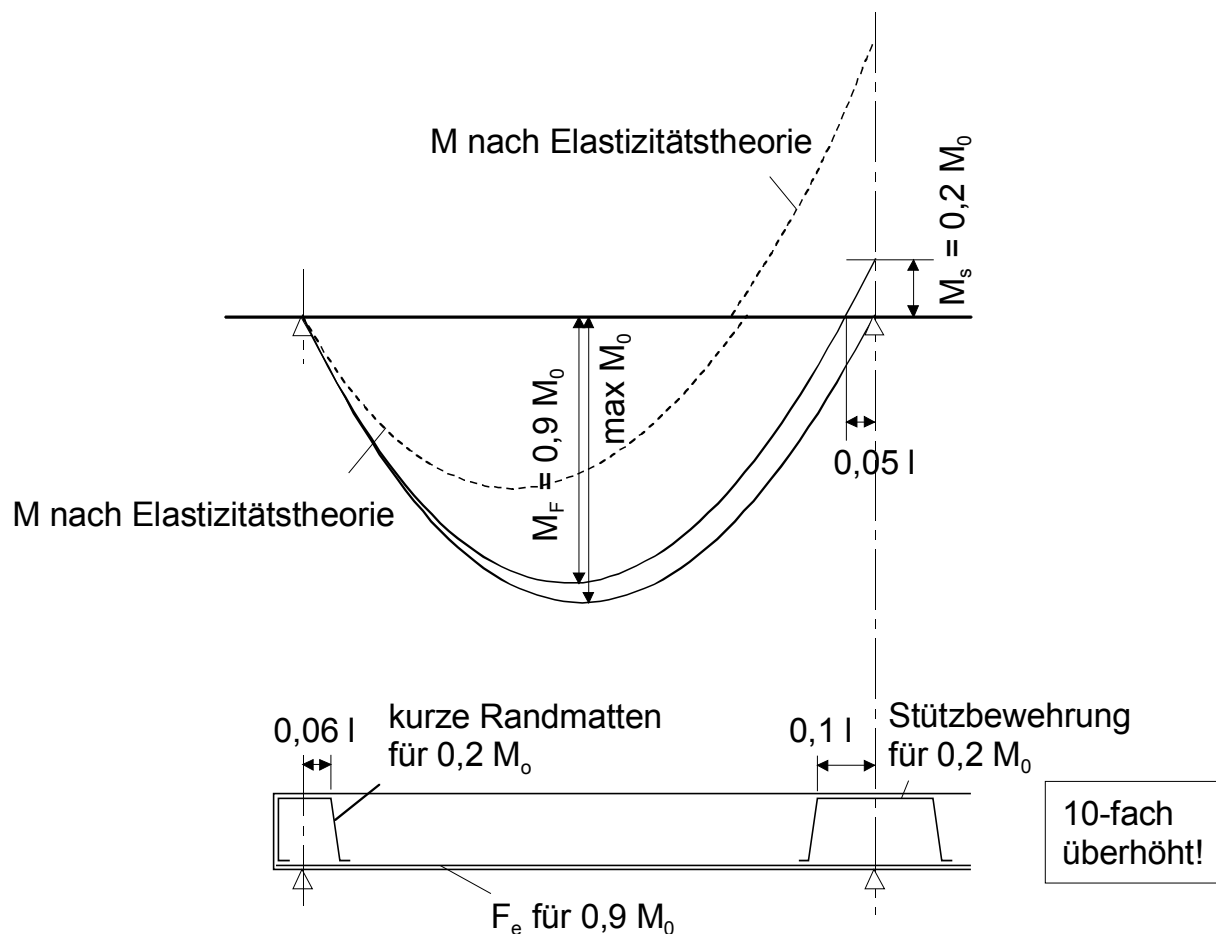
Vereinfachte Bewehrung mehrfeldriger Platten nach [Leon1]
